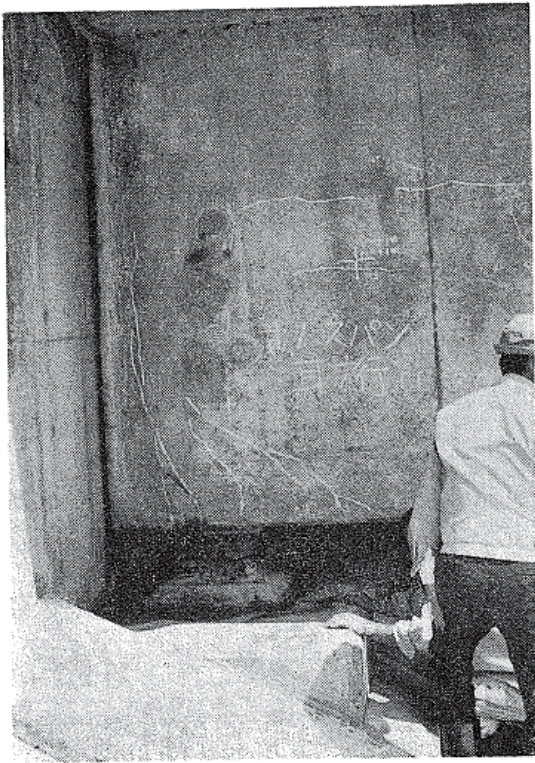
A1 橋台 G4 桁端部の損傷
